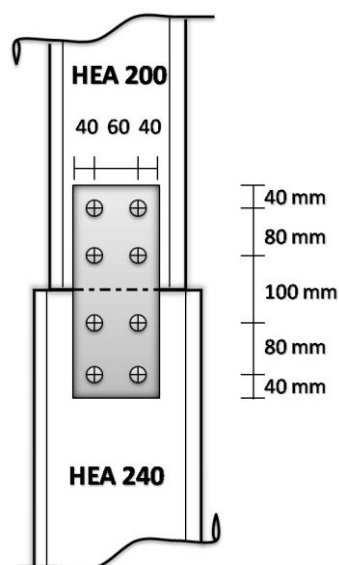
Assemblage poteau- poteau "couvre-joint de l'âme"
